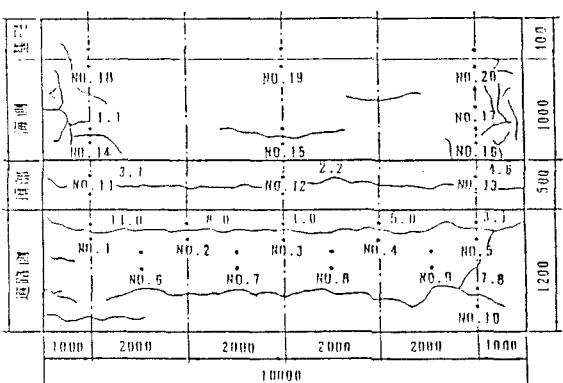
測定点の位置と初期ひびわれ幅 (単位 mm)
